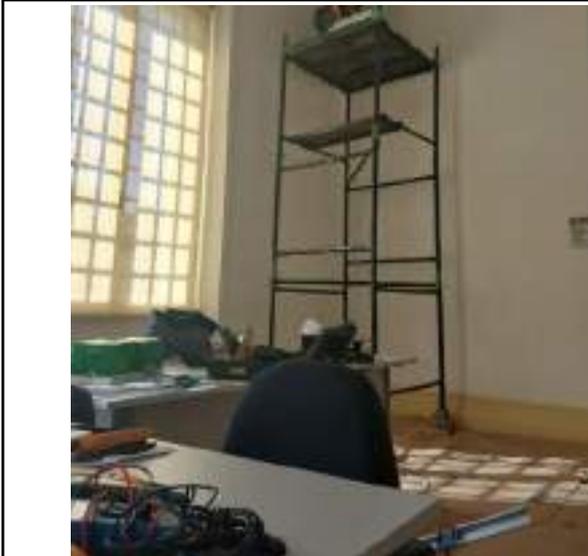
Instalação de infraestrutura para CFTV, Rede Wireless e ponto cabeado para lógica das mostras a serem instaladas nos ambientes das salas expositivas do primeiro pavimento.
